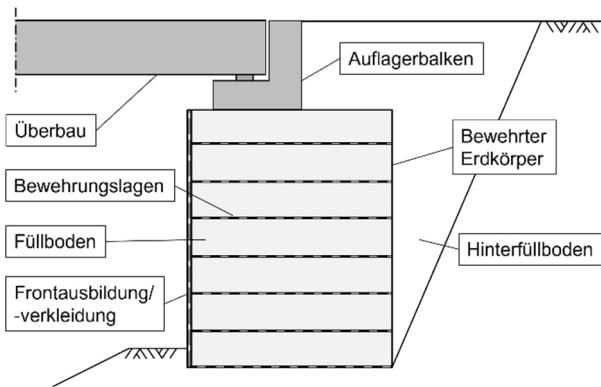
Prinzipdarstellung Widerlager aus bewehrter Erde
